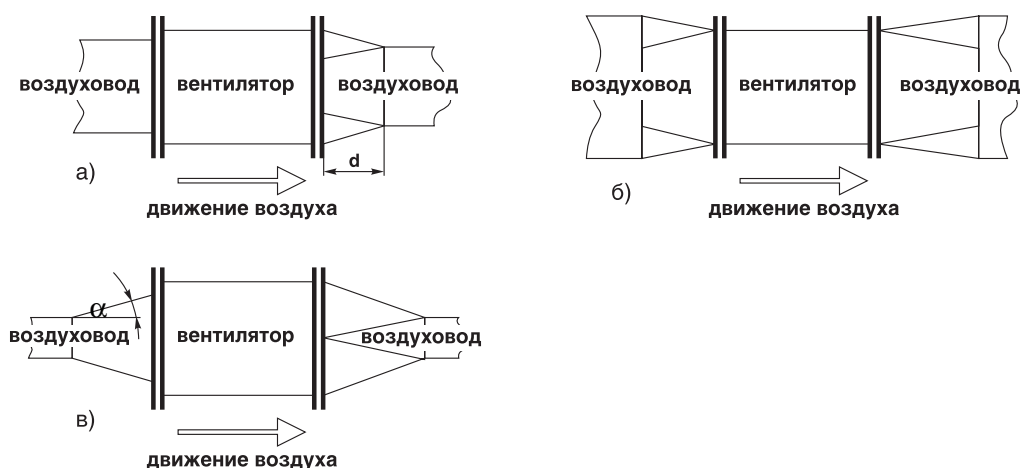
Соединения вентиляторов с круглыми воздуховодами
